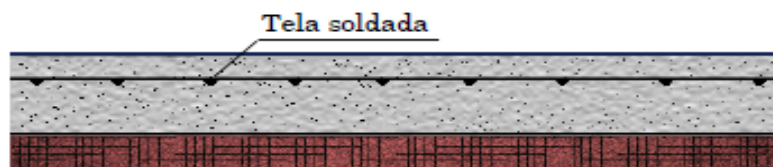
Perfil de um pavimento rígido em betão armado (Oliveira 2000)
